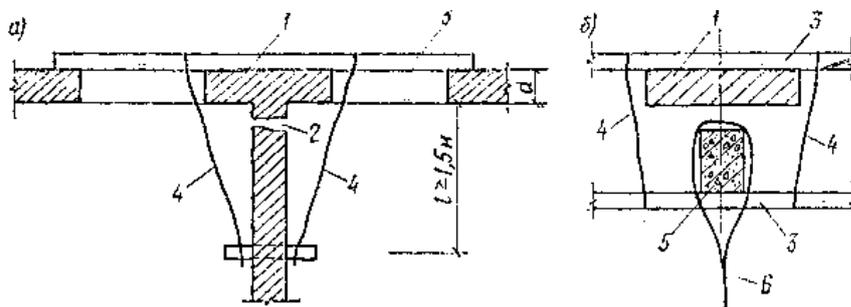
Крепление отклонившихся или выпучившихся стен хомутами-скрутками
